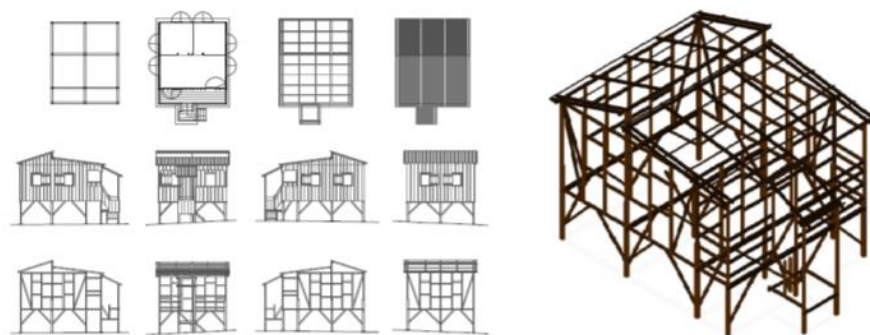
Cortes, plantas, alçados e estrutura de um palafita, (*)
